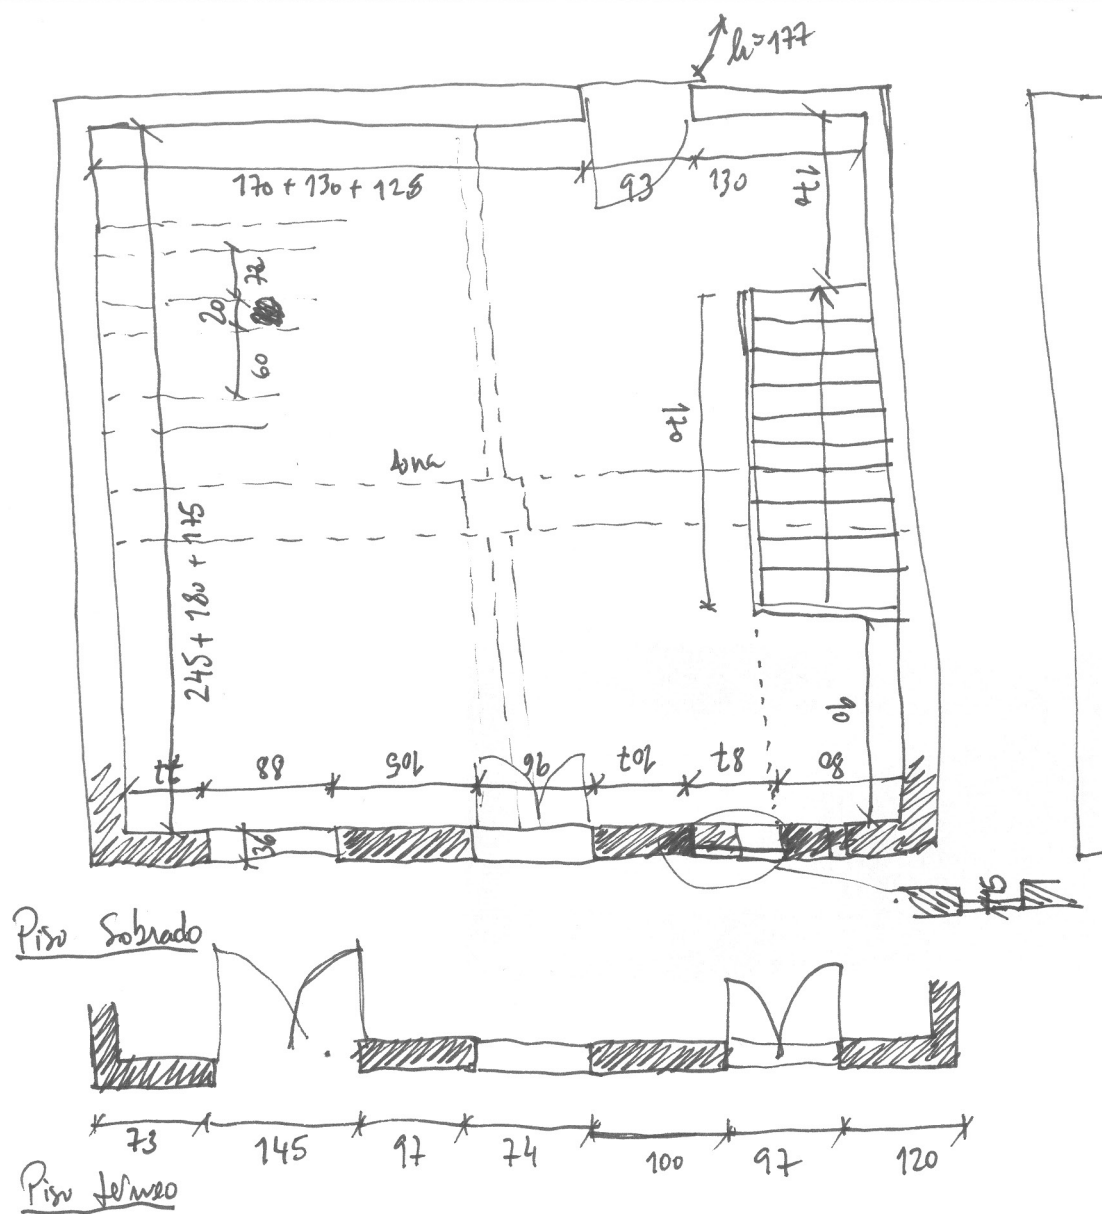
(à direita) Planta de levantamento. Casa Pátio de piso [AlbVelha6] , pág. 98
